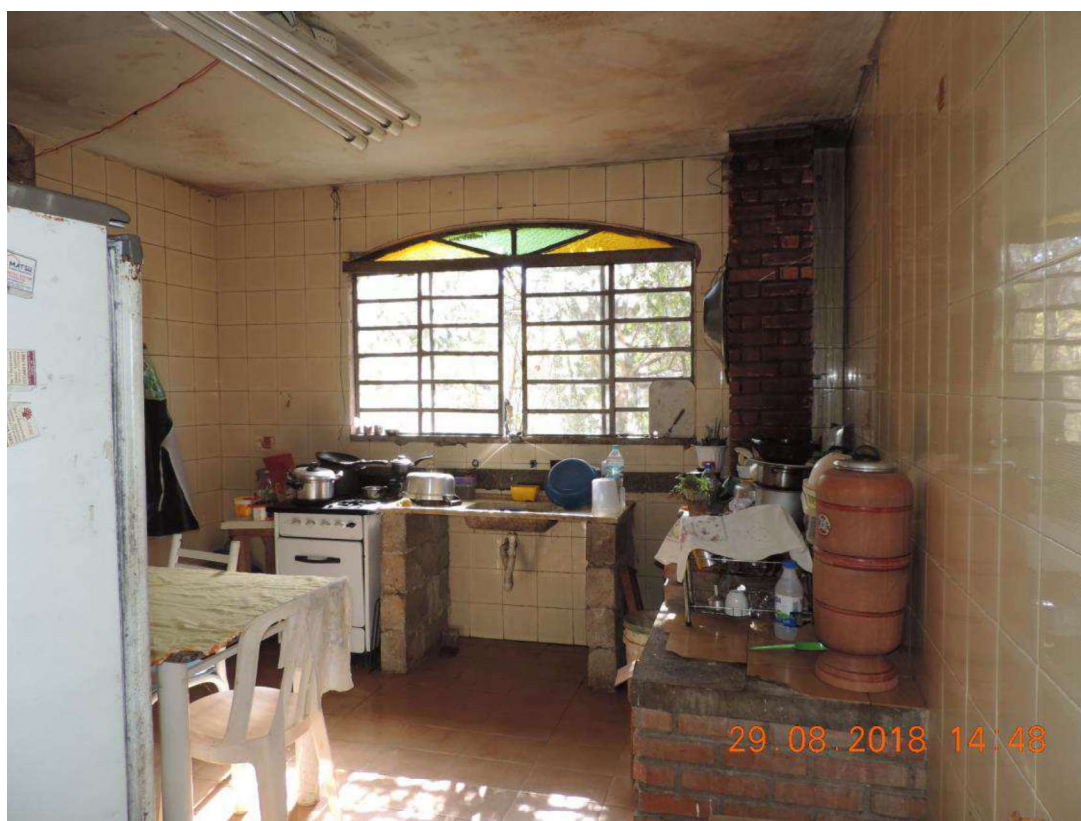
VISTA EXTERNA DA “ÁREA DA CHURRASQUEIRA”
